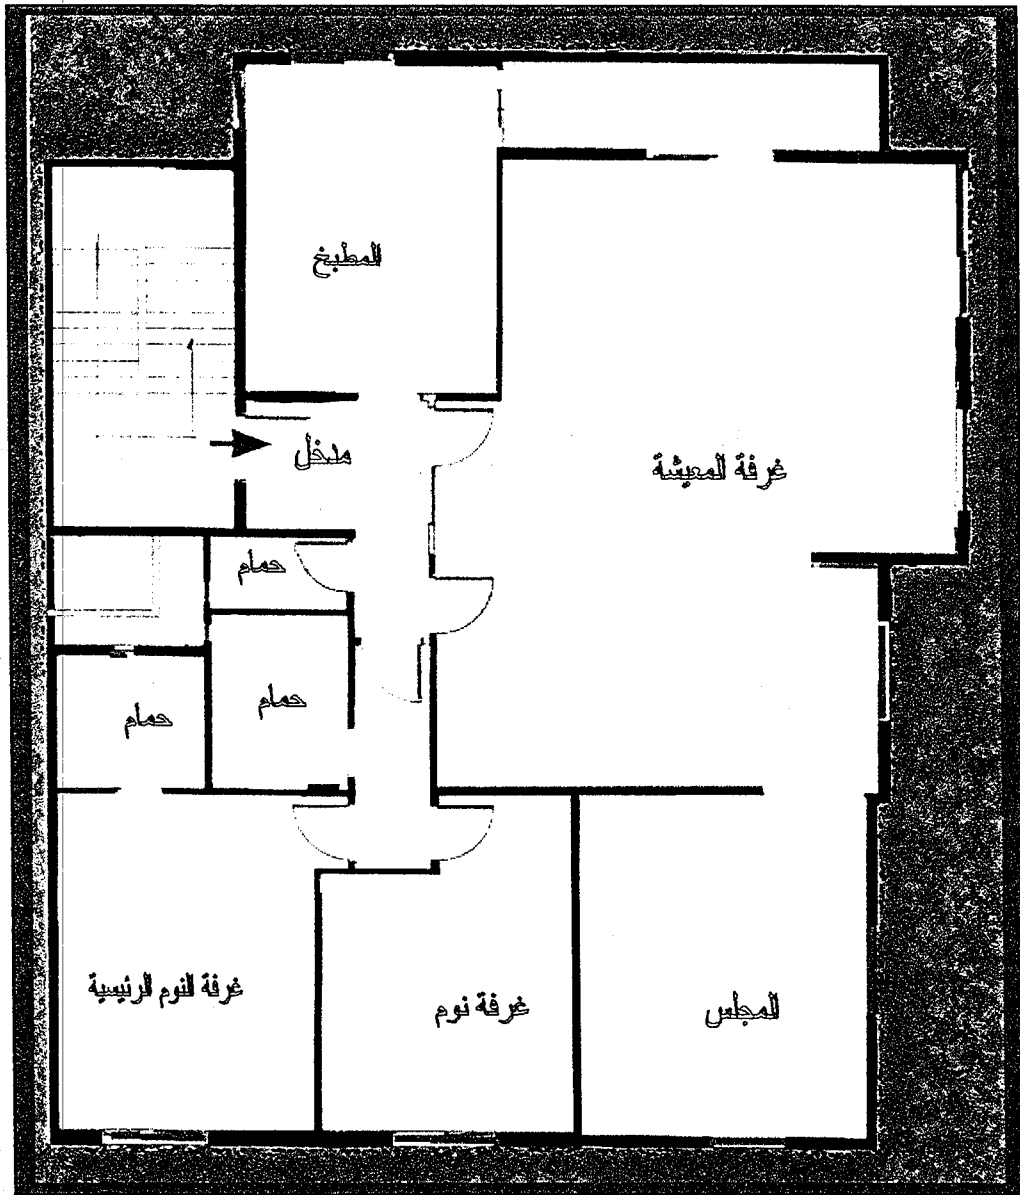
(٣/٢) مسقط أفقي بالدور الأول يوضح إتجاه المنظور في المدخل الرئيسي
